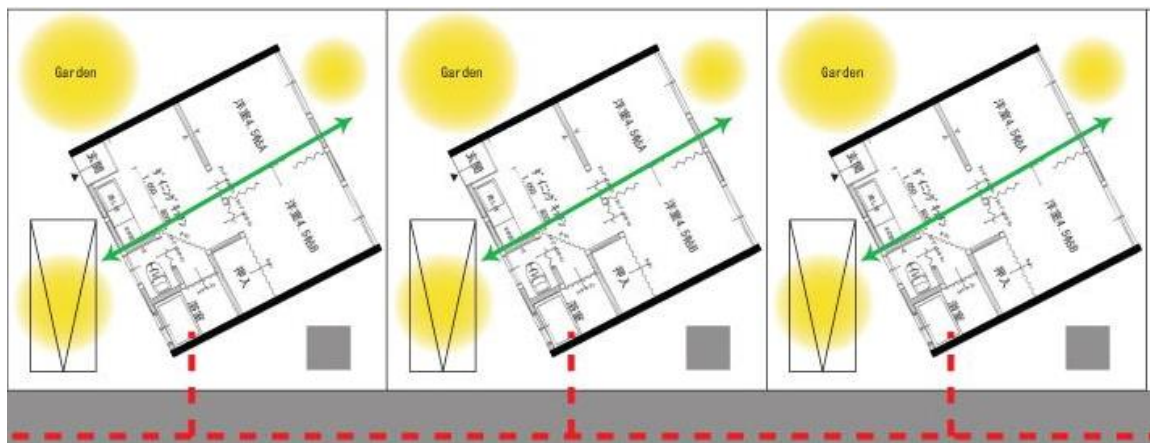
Planta. Fuente: Sumit Singhal. (2013).
